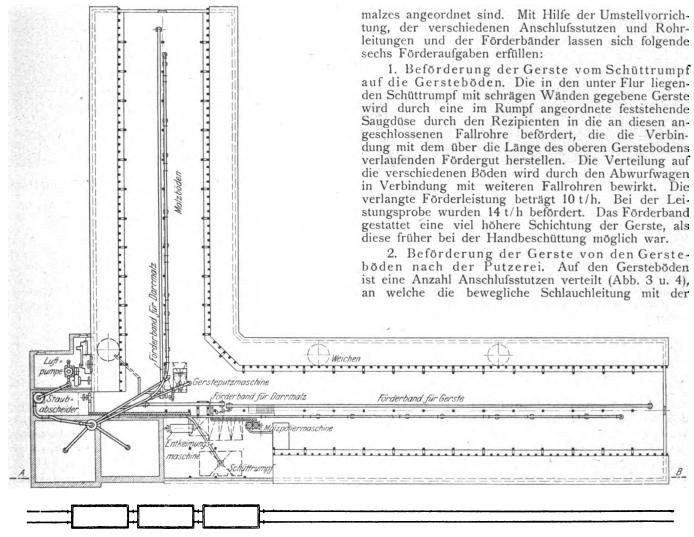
Pneumatische Förderanlage für Gerste, Grün- und Darrmalz. Grundriss.
